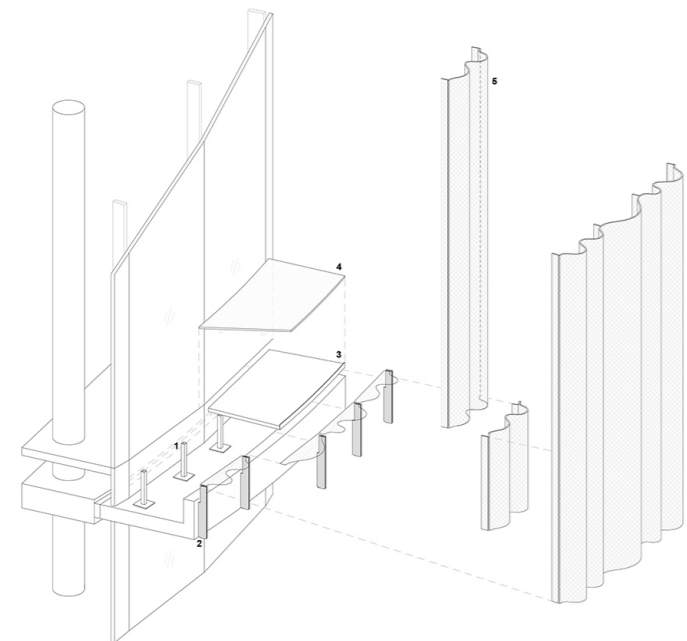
Detalle constructivo del anclaje de la malla a la estructura y cerramiento de vidrio con acabados.
